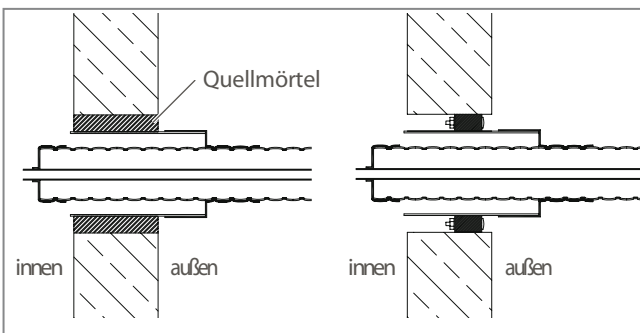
Einbauschema Stützhülse mit aufgerauter Oberfläche (links) und glatter Oberfläche (rechts)
